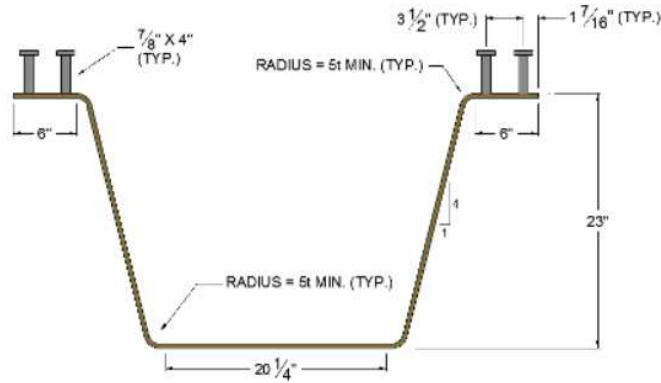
Sección transversal de viga metálica de chapa plegada, The Short Span Steel Bridge Alliance (SSSBA)
